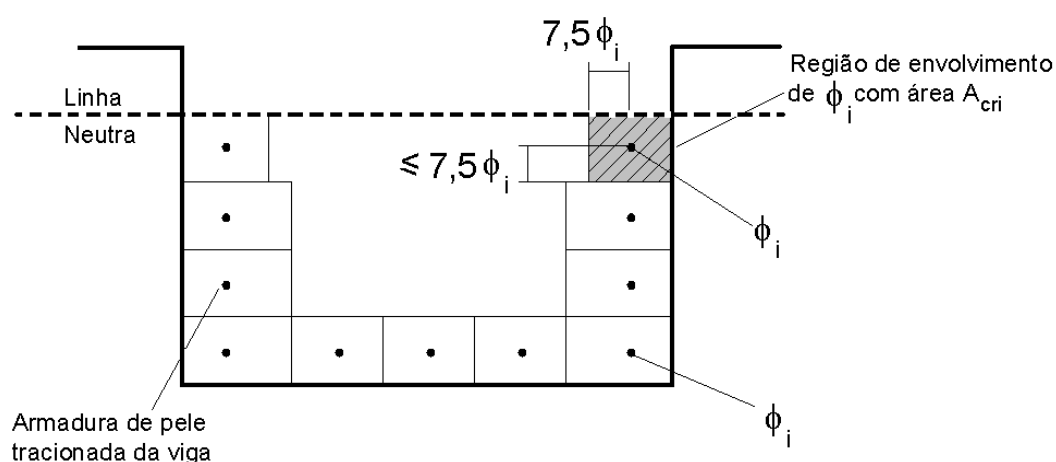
Concreto de envolvimento da armadura (Figura 17.3 da NBR 6118:2003)
